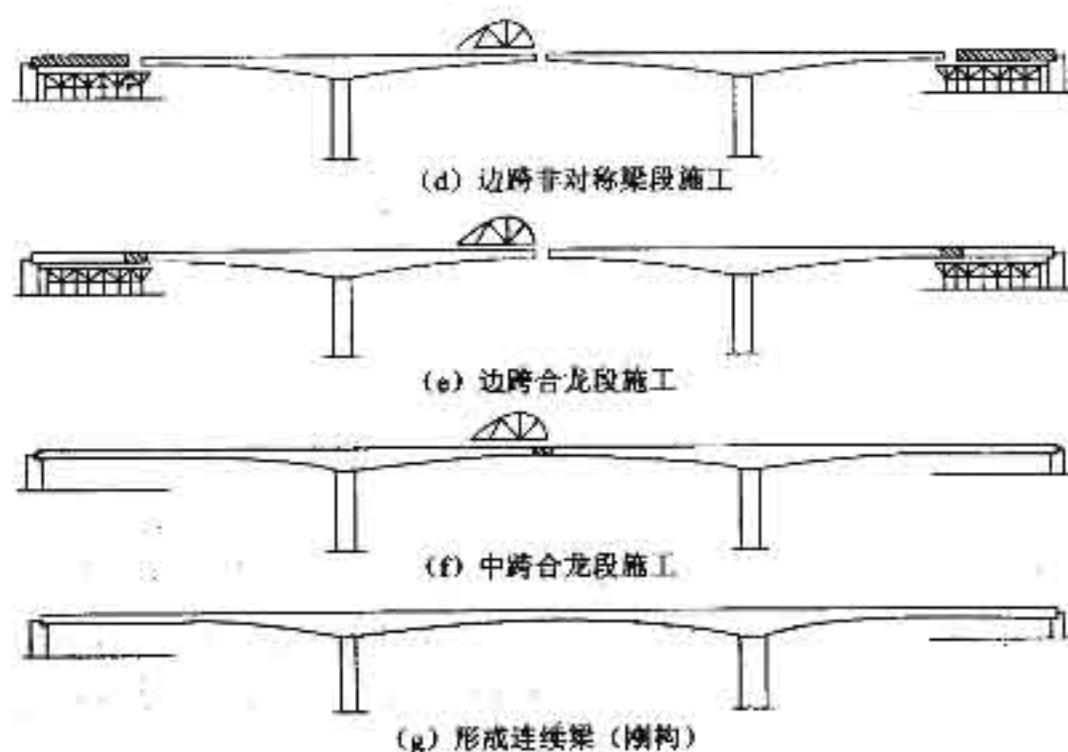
连续梁(刚构)悬臂浇筑施工方法示意图
